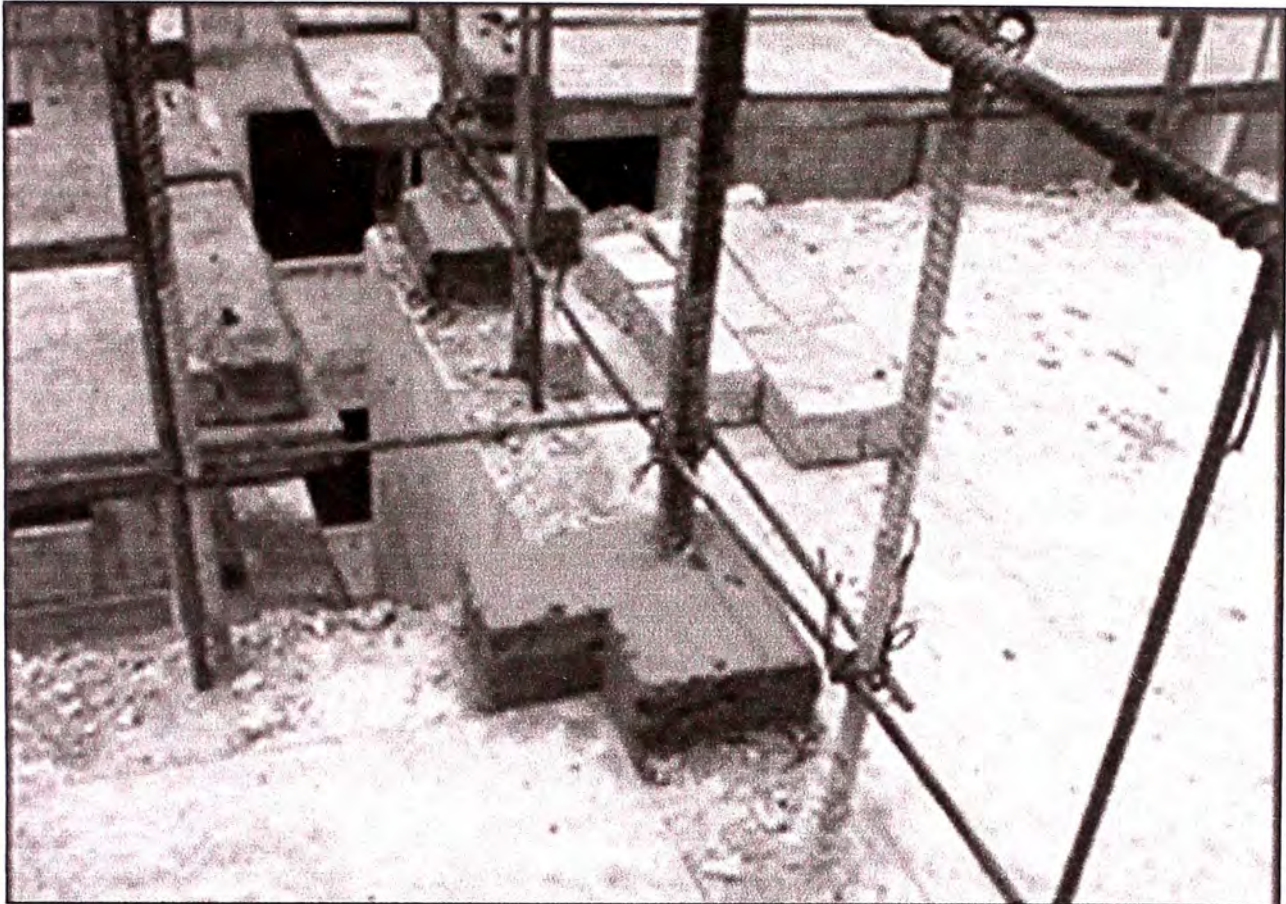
Trazo y emplantillado de concreto para facilitar el encofrado
